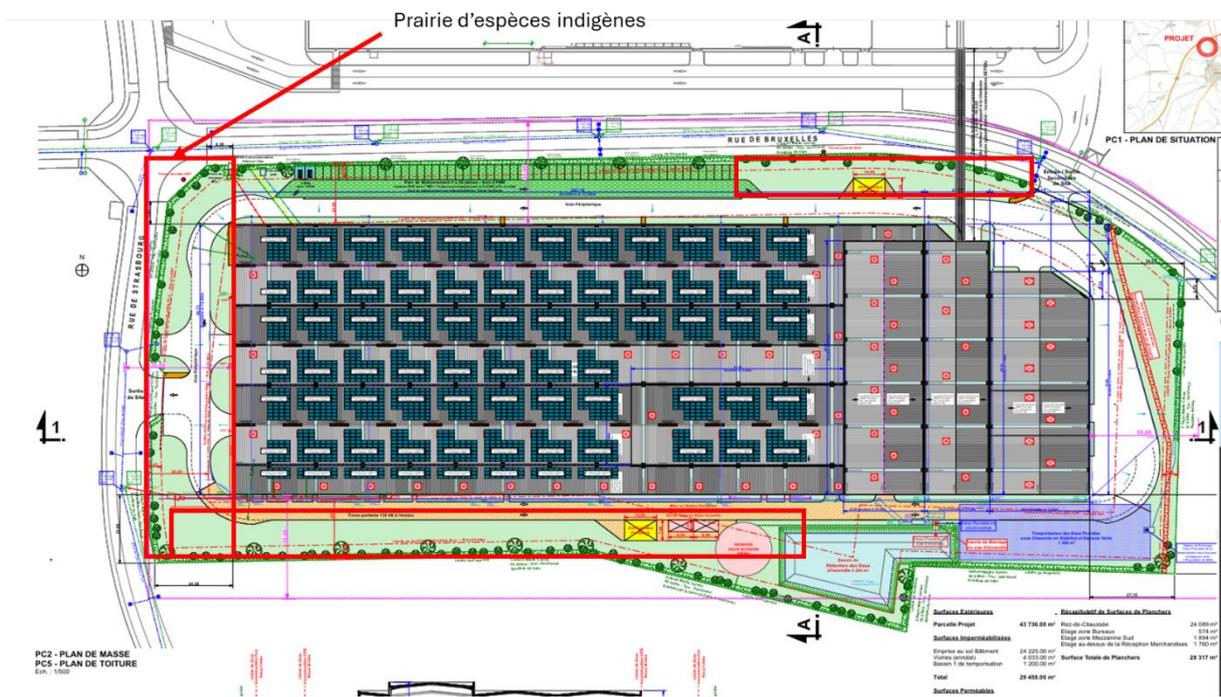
Localisation des milieux prairiaux du site Cortizo (source : plan masse de janvier 2025)
